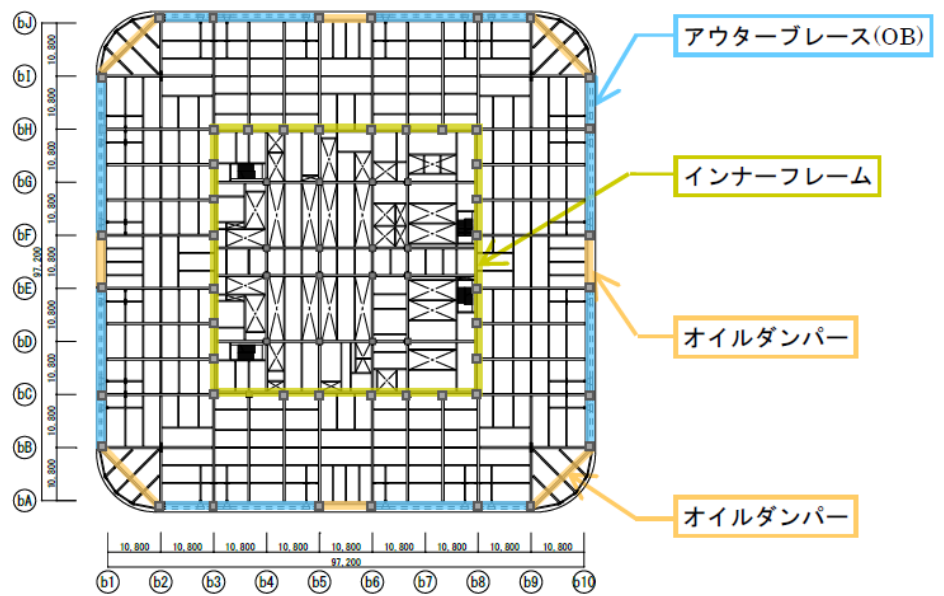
TOKYO TORCH Torch Tower の基準階平面プラン ²⁹⁾
